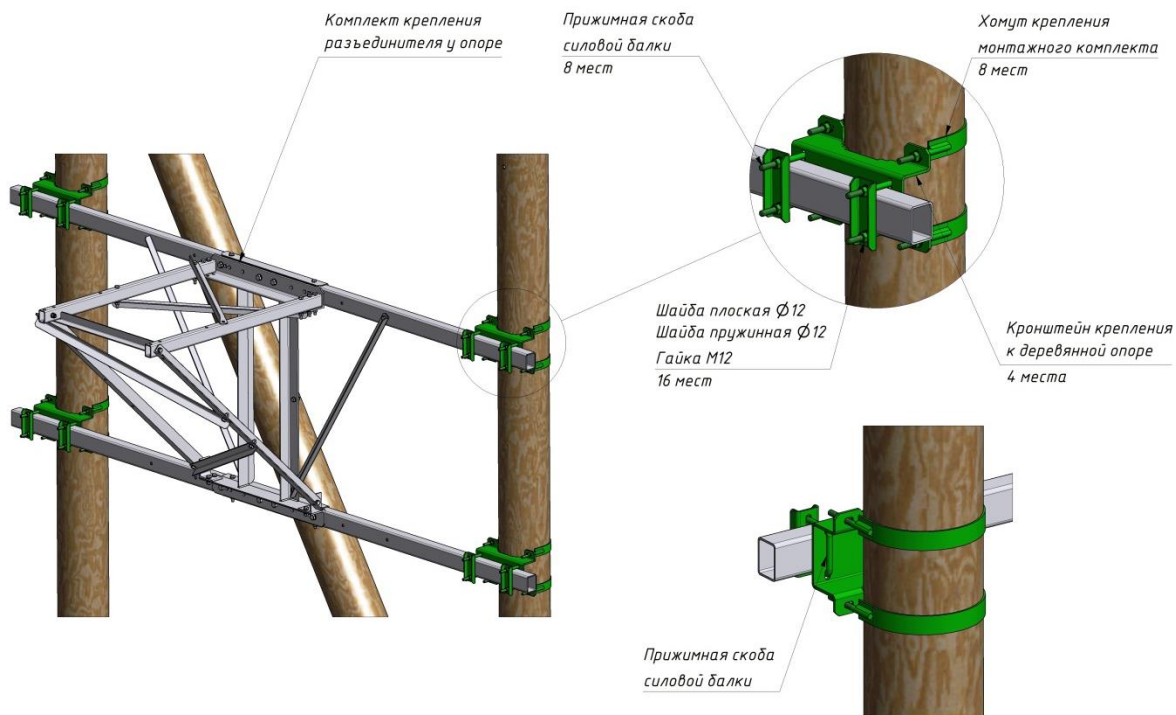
Установка кронштейна разъединителя на деревянную опору
